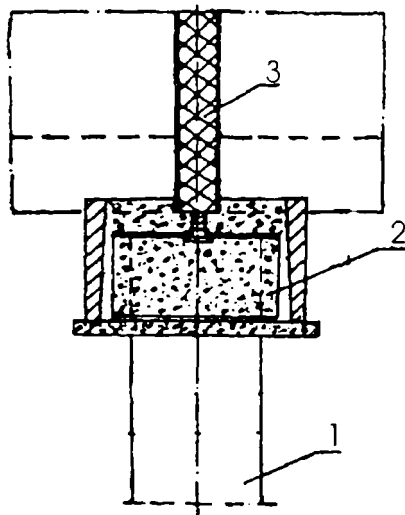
Sistem de fundații prefabricate (Ungaria): 1 - pilot prefabricat; 2 - grindă din beton turnat monolit; 3 - panou de elevație.
